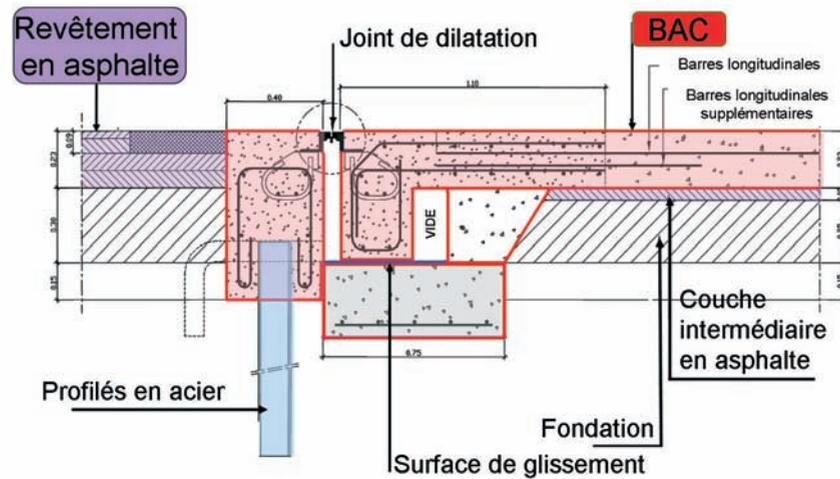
Section transversale du joint d'extrémité utilisé sur le R1
